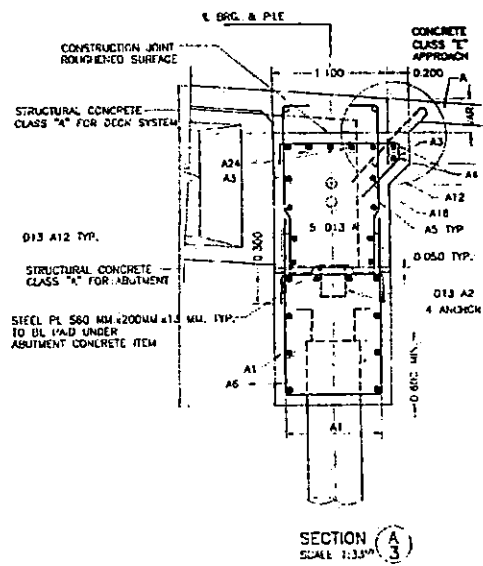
SECCION DEL ESTRIBO.
